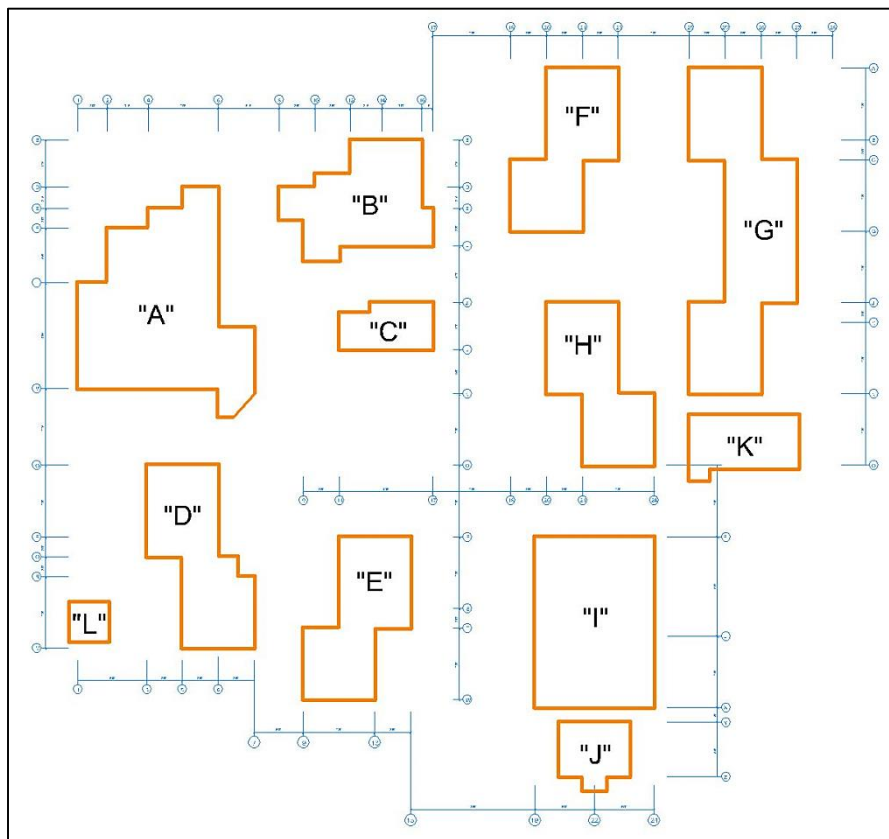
Vista en Planta de la Distribución de los 12 Edificios
